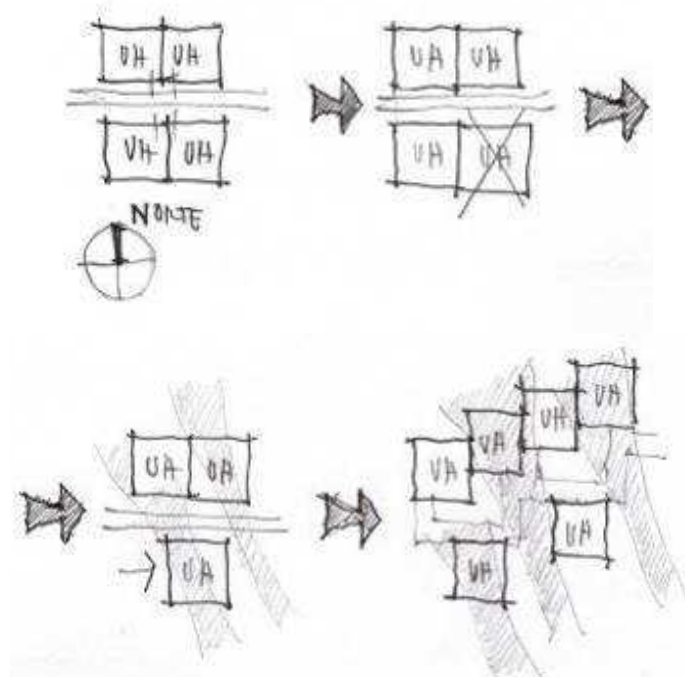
Croquis de planta baixa da evolução do partido adotado.
